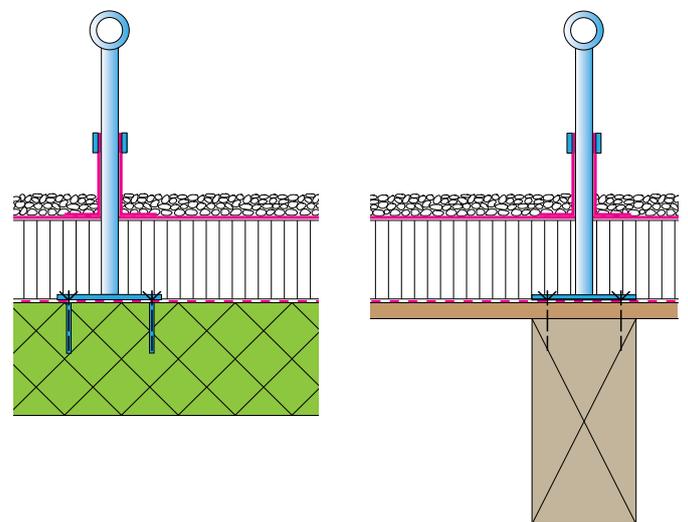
Ausstattungs-klasse 1: EAP auf einem wärme-gedämmten Flachdach eingebaut, Variante auf einer Beton- und einer Holzunterkonstruktion
